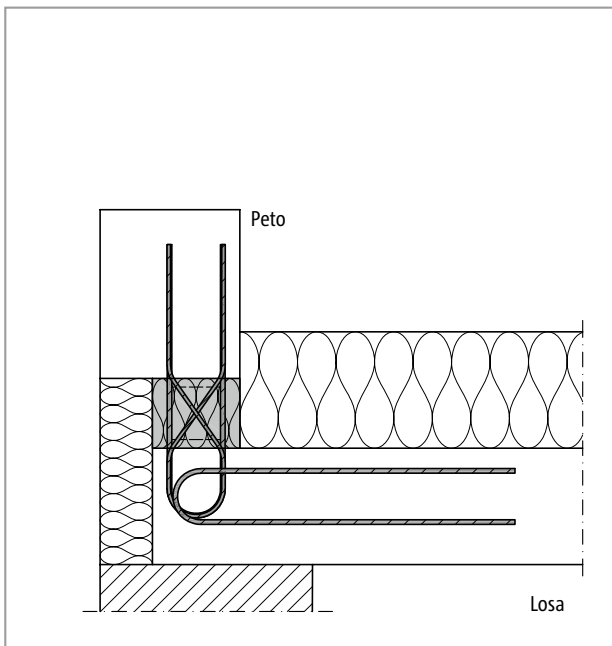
Schöck Isokorb® XT tipo A: Conexión de un peto (XT tipo A-MM1)
